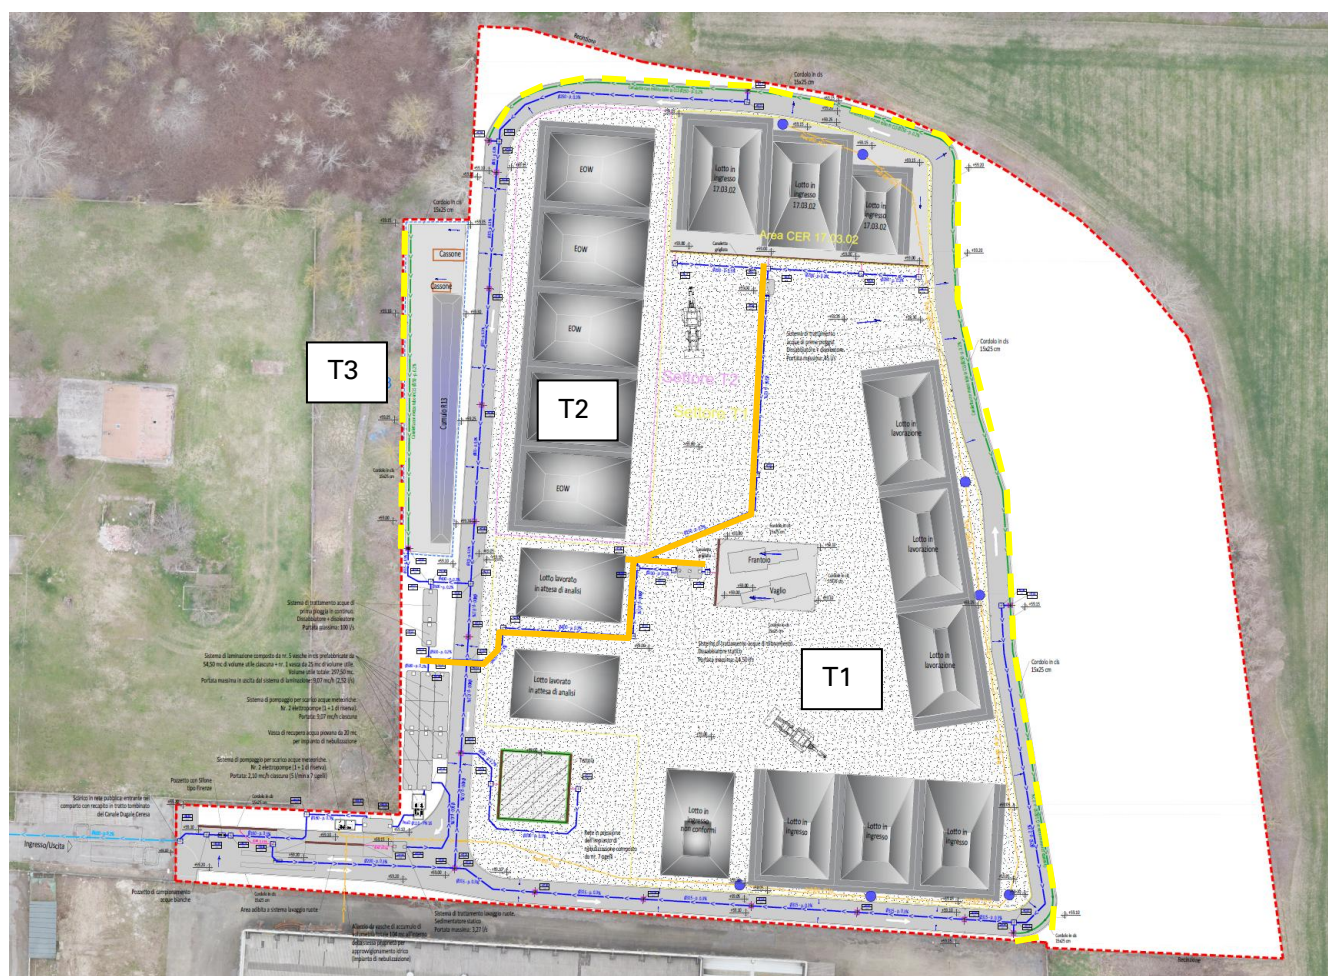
Planimetria stato di progetto - Rete smaltimento acque meteoriche
